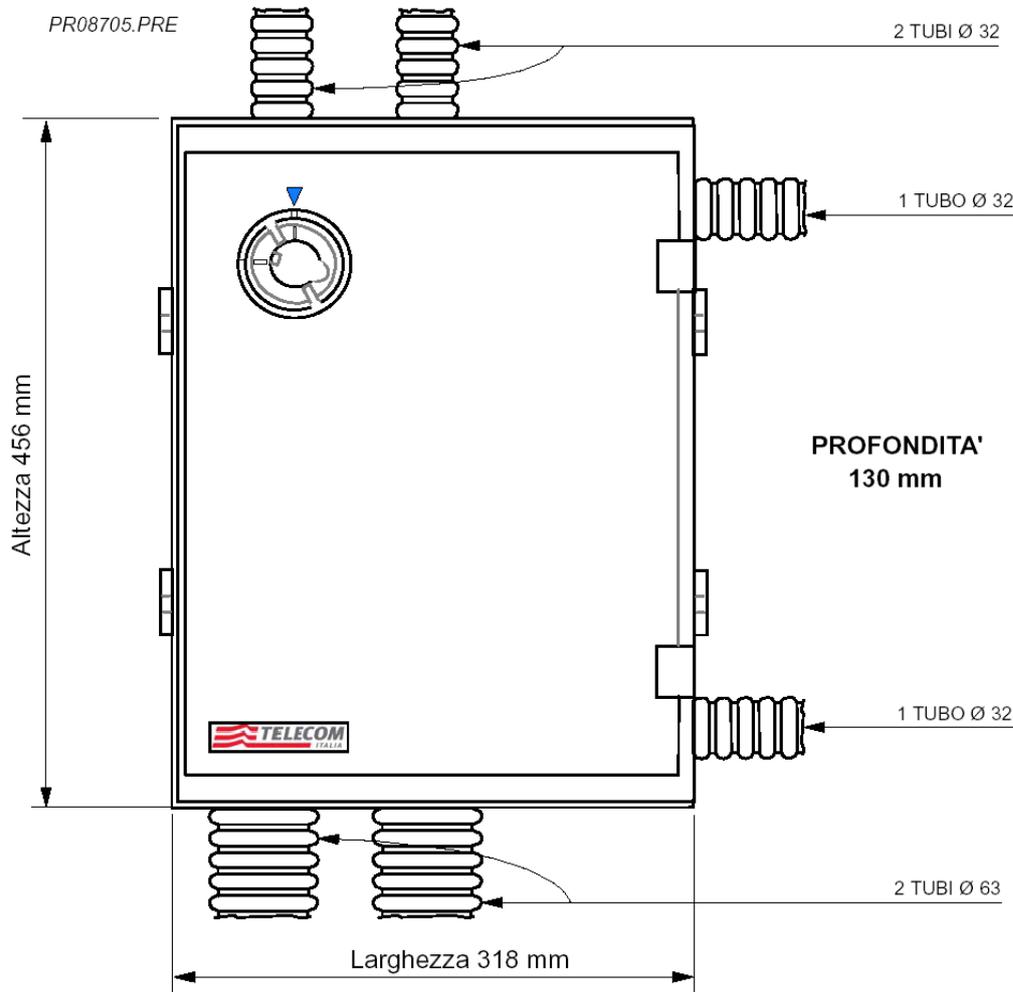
Armadietto da incasso tipo “C” con i tubi di raccordo
